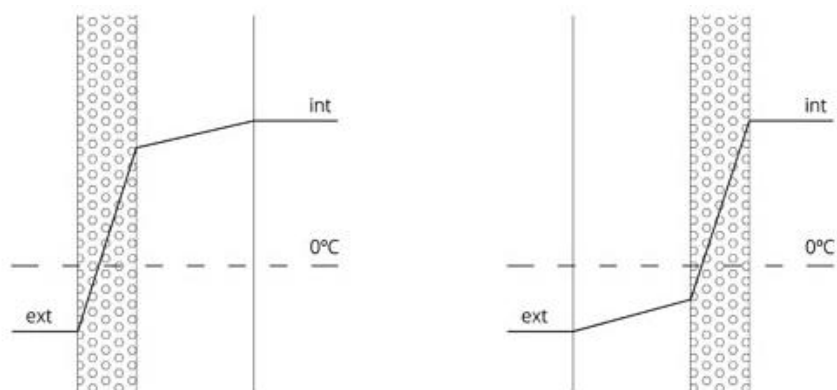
Ubicación Capa de Aislamiento Térmico. Izquierda, aislamiento por exterior. Derecha, aislamiento por interior. Adaptado de Caballero (2017)
